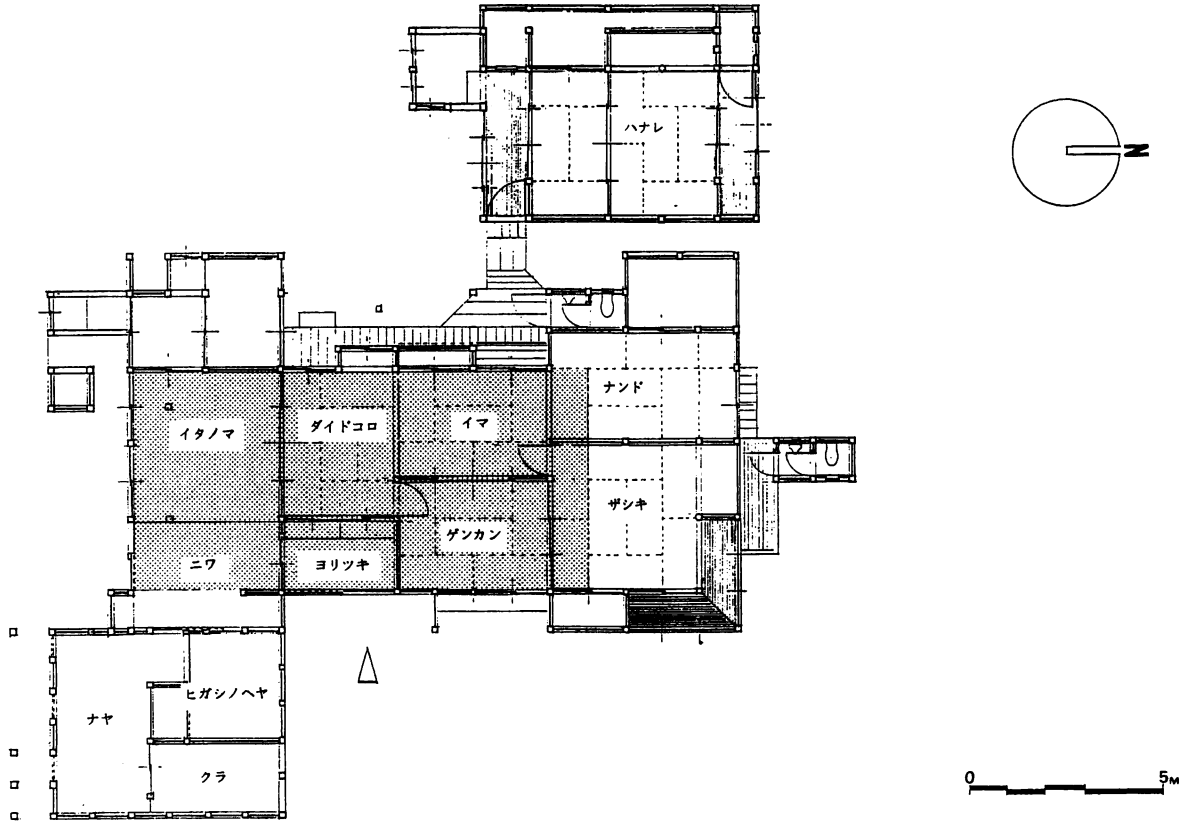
笠原家住宅平面図 (1/100) (アミかけ部分は、推定の当初平面)
